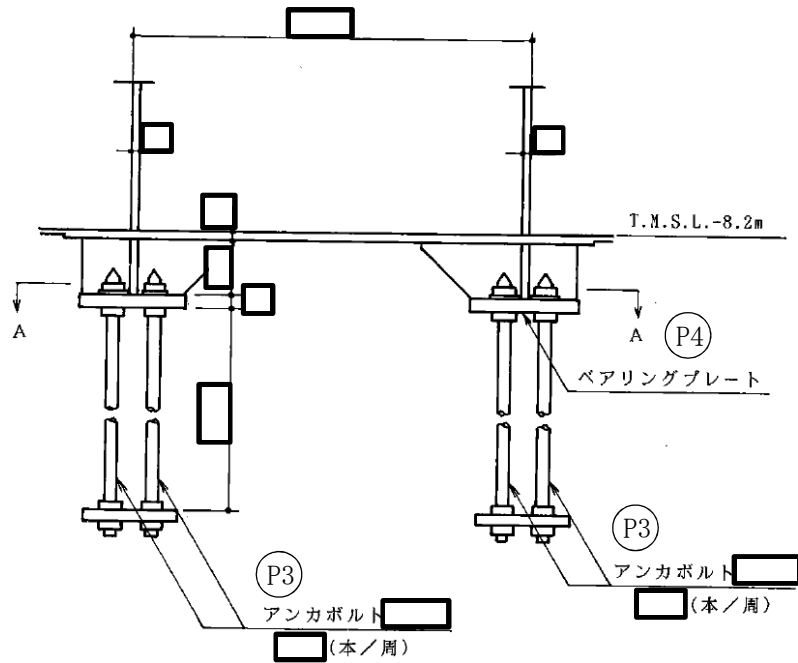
原子炉本体の基礎の応力評価位置 (その 1) (設計基準対象施設) (単位: mm)
